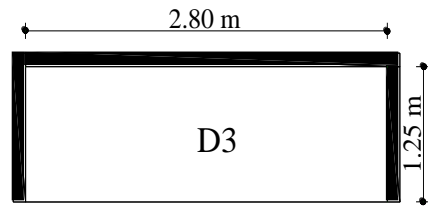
Schéma de ferrailage de la dalle pleine sur quatre appuis
